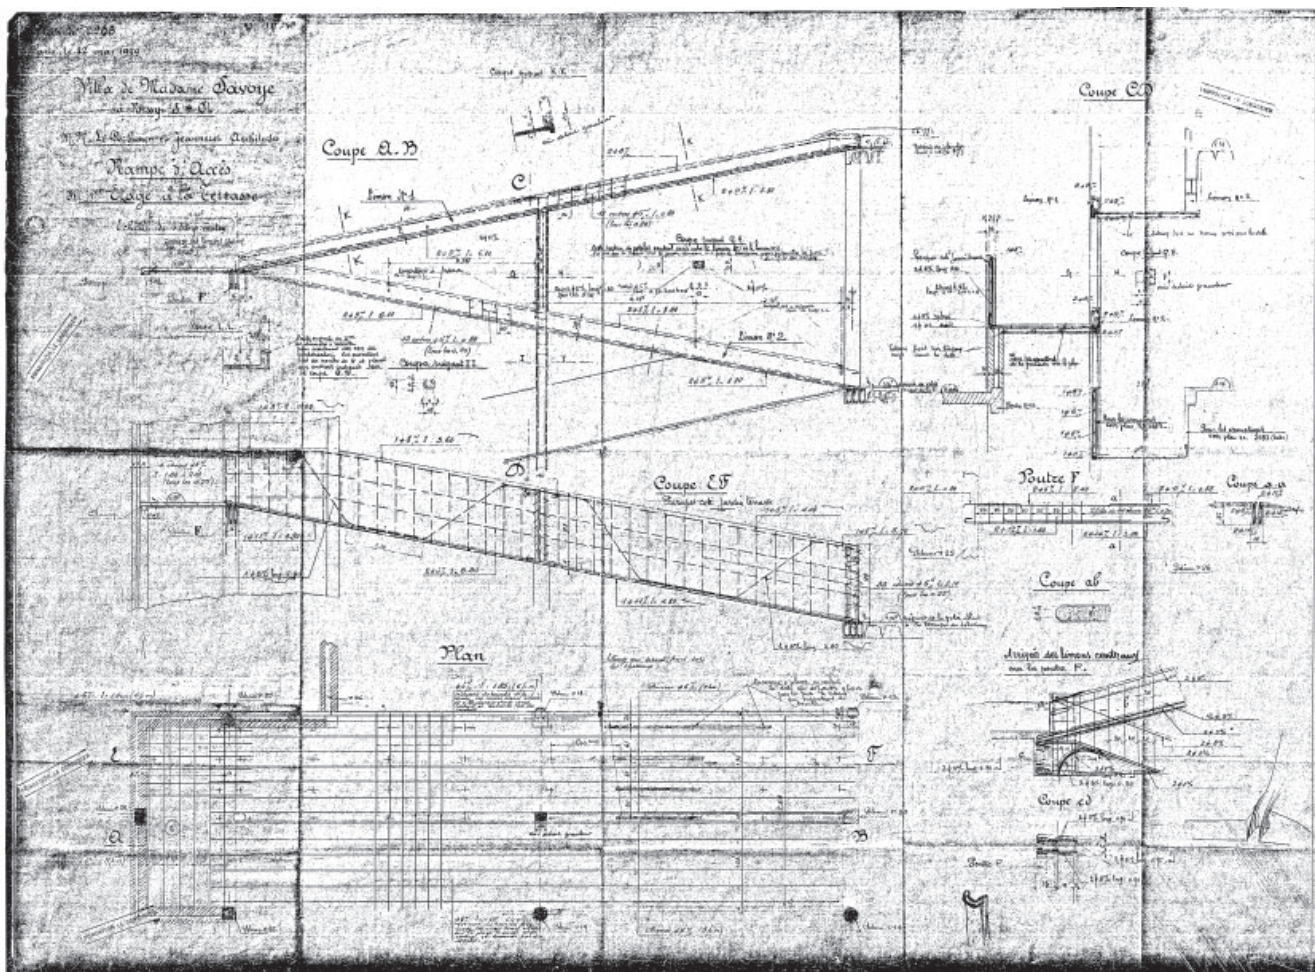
"Plan n° 2206 / Rampe d'Accès / du 1er Etage à la Terrasse" de la Villa Savoye, a escala 1:50, Cormier, 22-5-1929. FLC H1 (13) 309.
